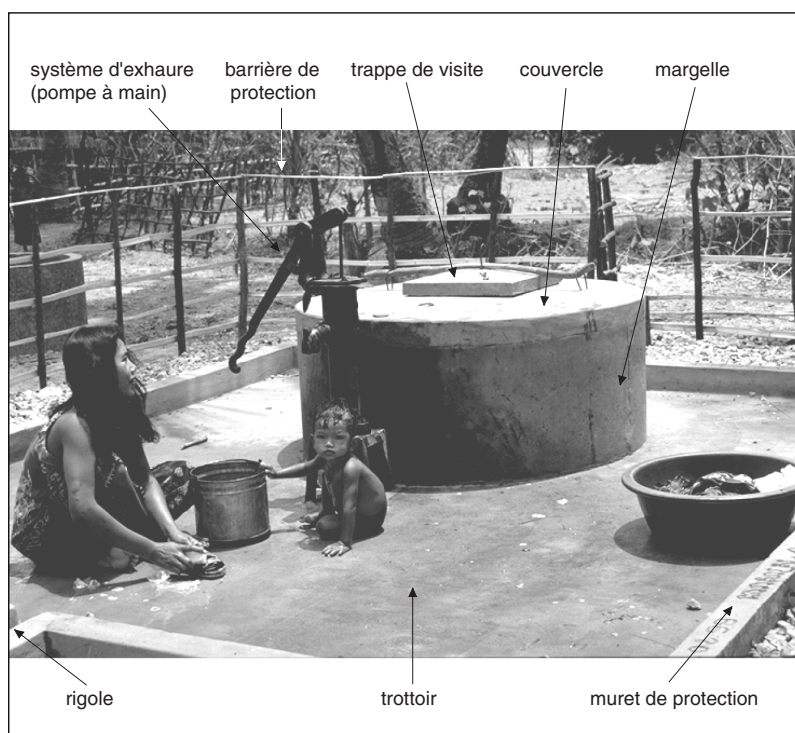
Aménagement de surface de puits (ACF Cambodge, 1998).
